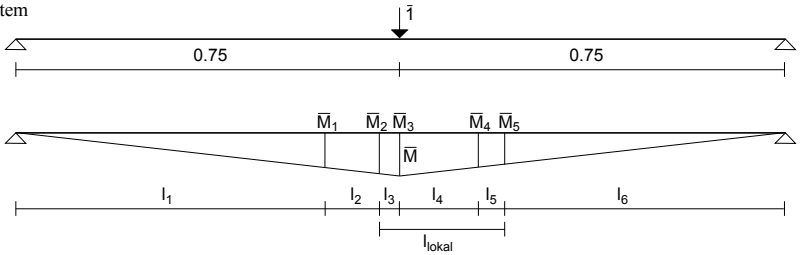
Bestimmung der Krümmung im Makroriss für Fall D (große Balken aus Normalbeton)
